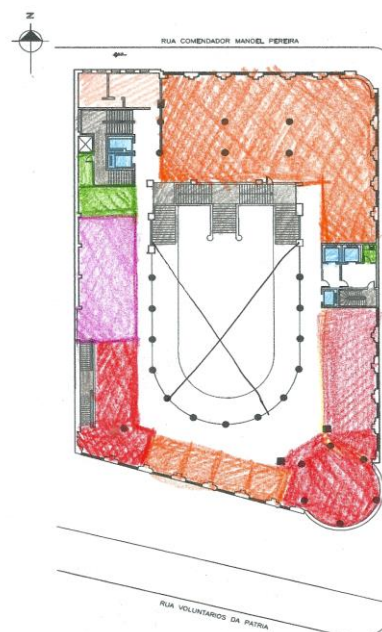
Planta Baixa Sobreloja - Mapa de Manchas com zonamento da proposta de intervenção.
